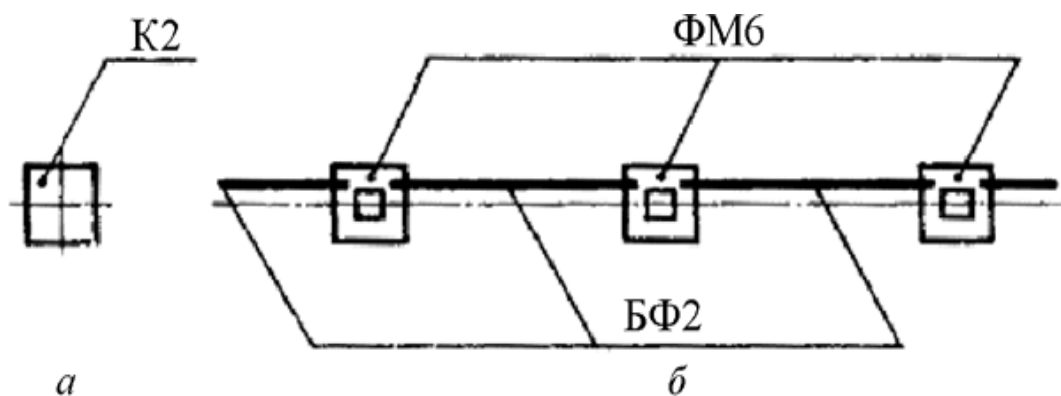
Маркировка железобетонных изделий: *а* — отдельной колонны; *б* — монолитных фундаментов и фундаментных балок
